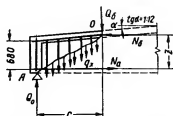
Расчетная схема для определения усилия, передаваемого продольными стержнями на анкерное устройство.
